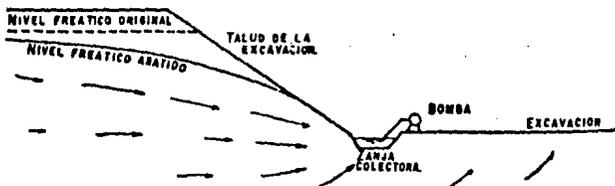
Control de flujo hacia una excavación poco profunda con zanjas colectoras
